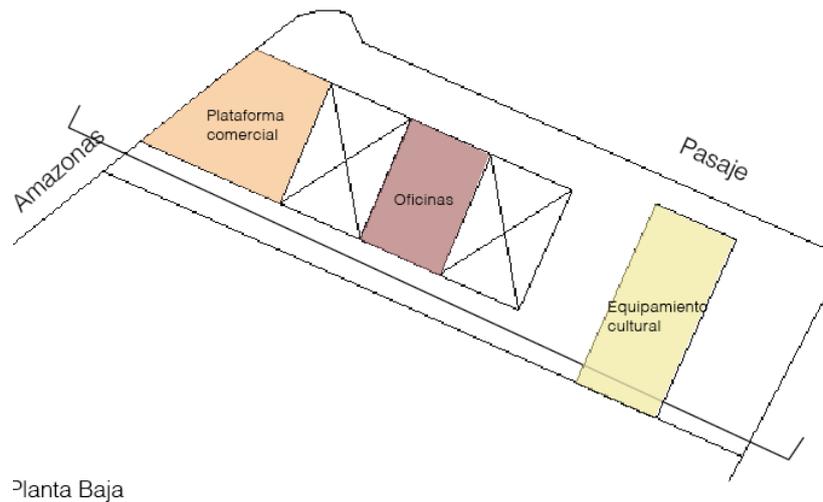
Distribución de programa en planta baja. (Elaboración propia)
